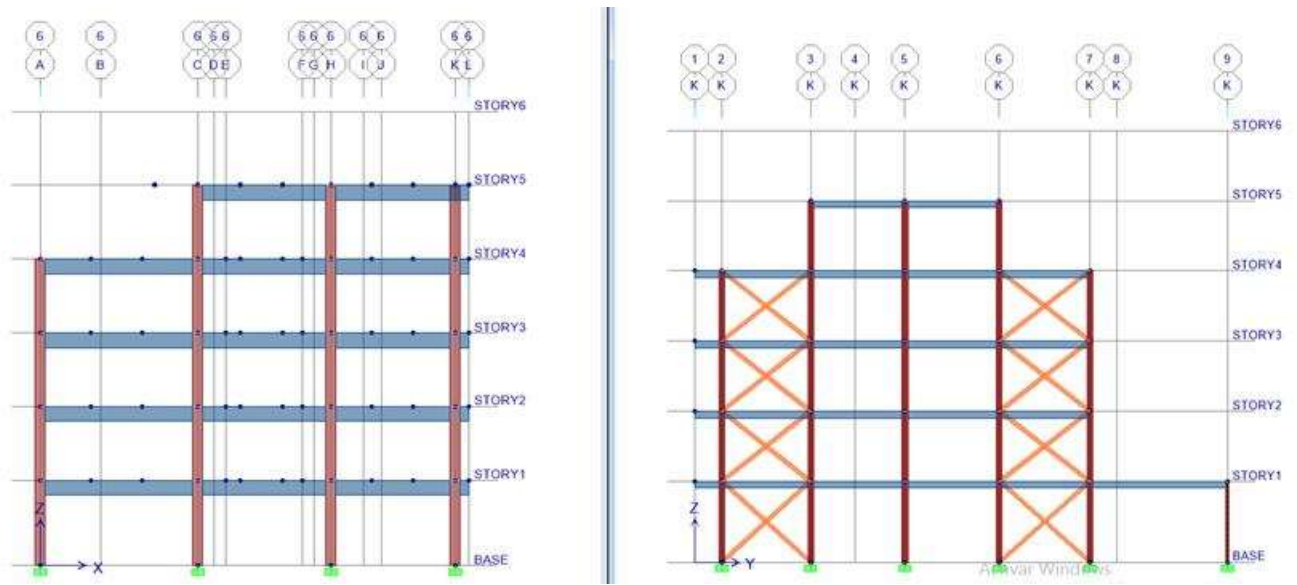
Esqueleto Estructural para el proyecto ETABS – Vistas Laterales
